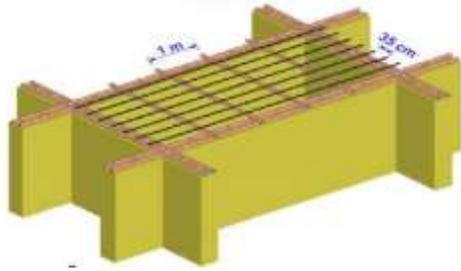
Renforcement horizontal par chaînage en bois au niveau de la toiture
